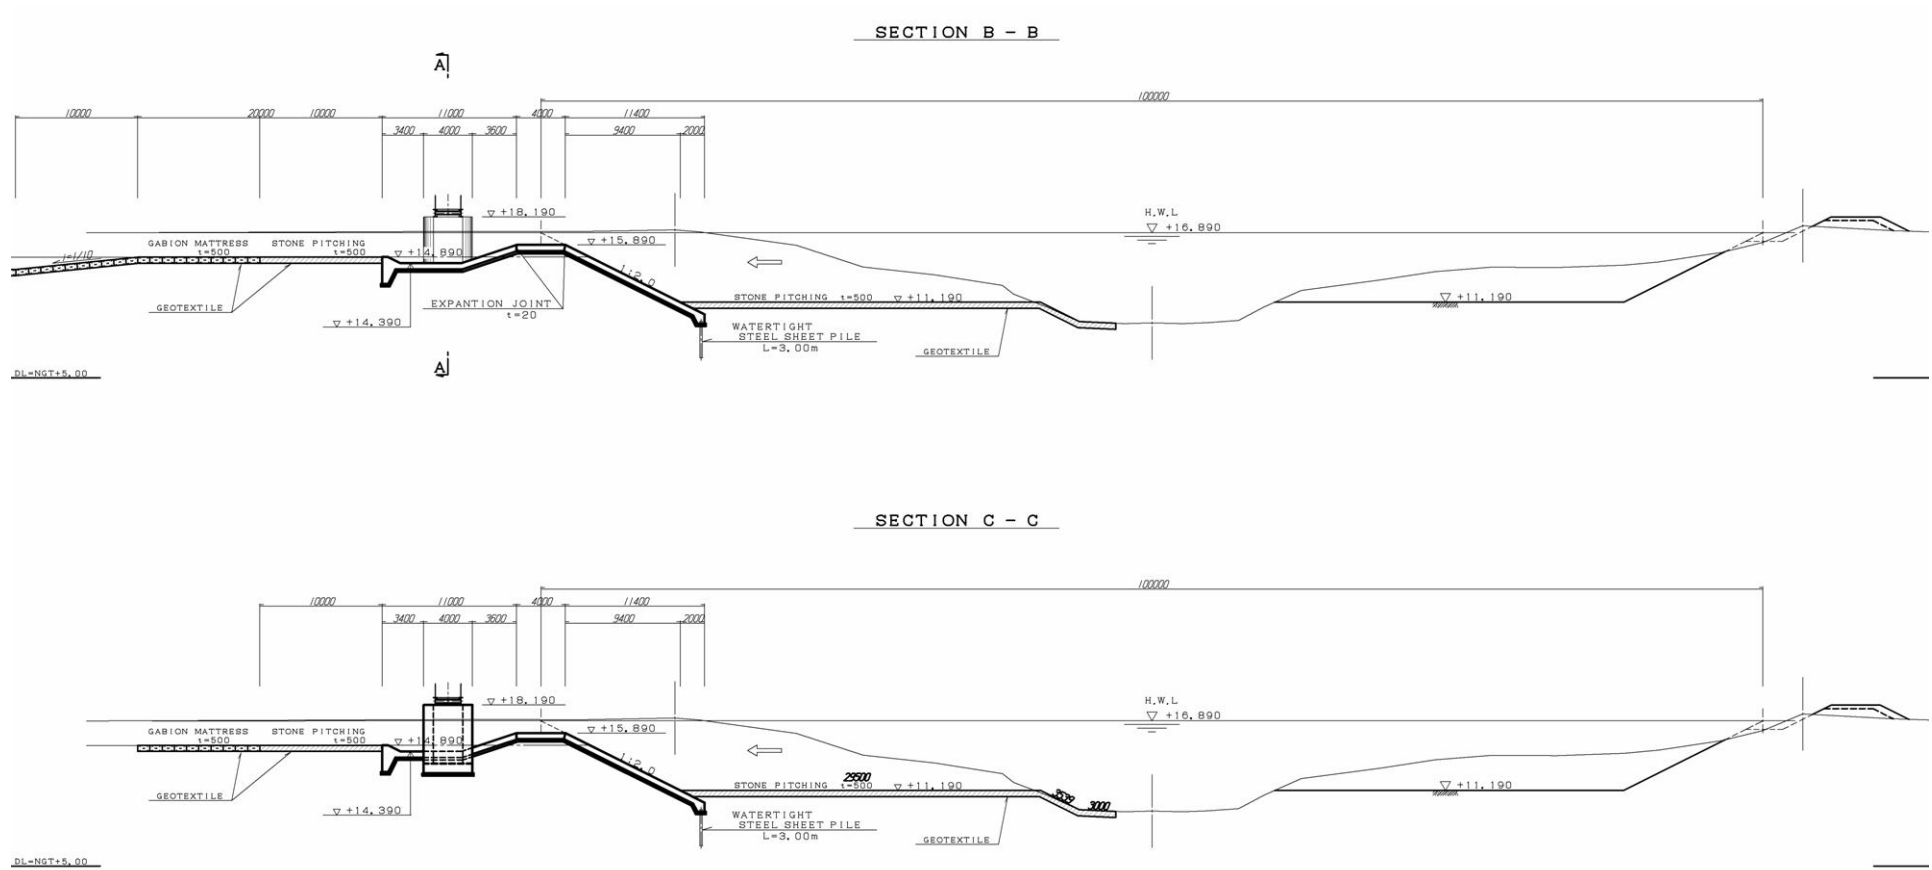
遊水地への分流堰 B-B 断面及び C-C 断面図
